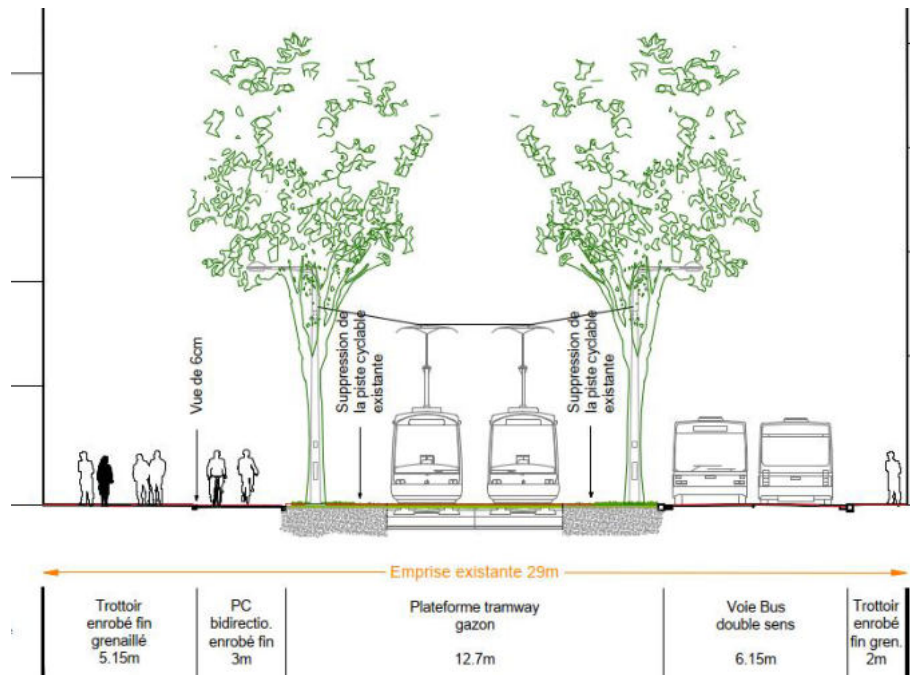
VUE EN COUPE ET EN PLAN BLD WILSON (SECTION SUD)
